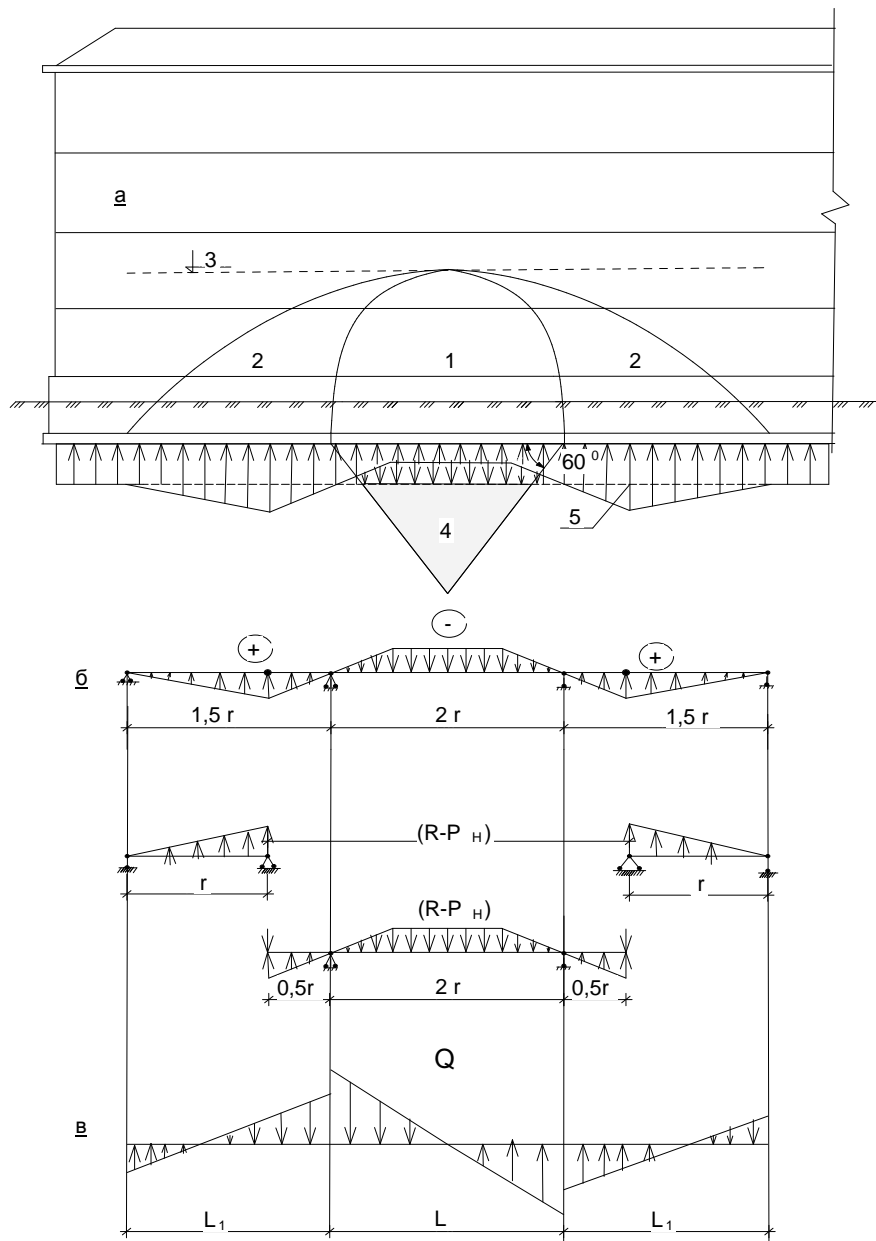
Расчетная схема наружной стены: а) фрагмент фасада; б) расчетная схема наружной стены.
